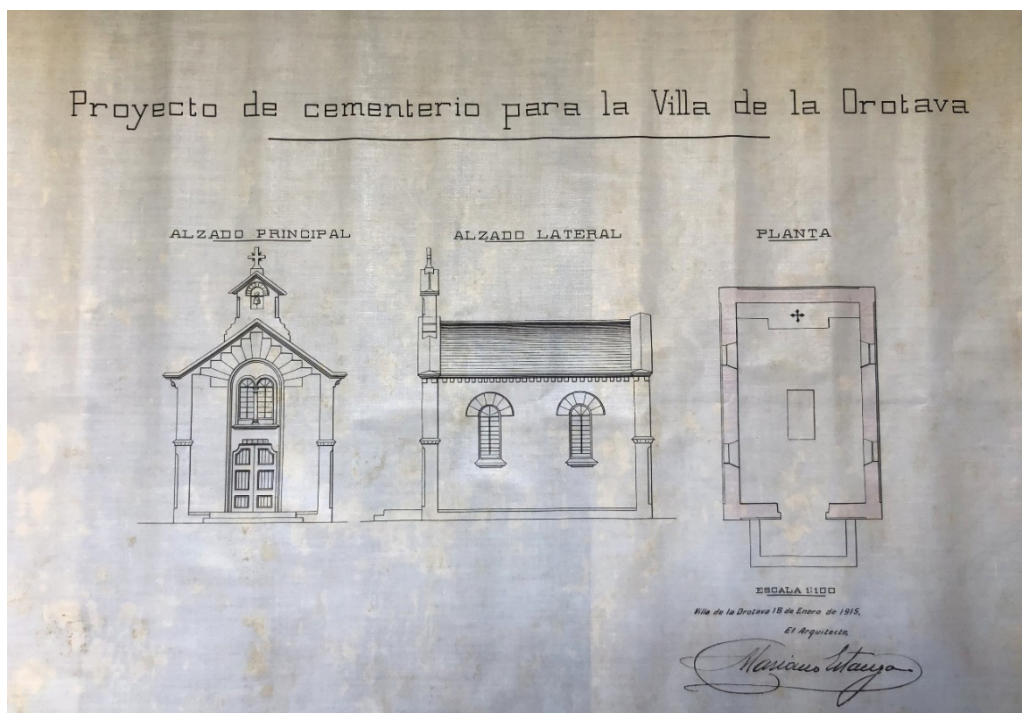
Mariano Estanga: *Proyecto de cementerio para la Villa de La Orotava. Alzado principal, alzado lateral y planta de la capilla.* Foto del autor.
